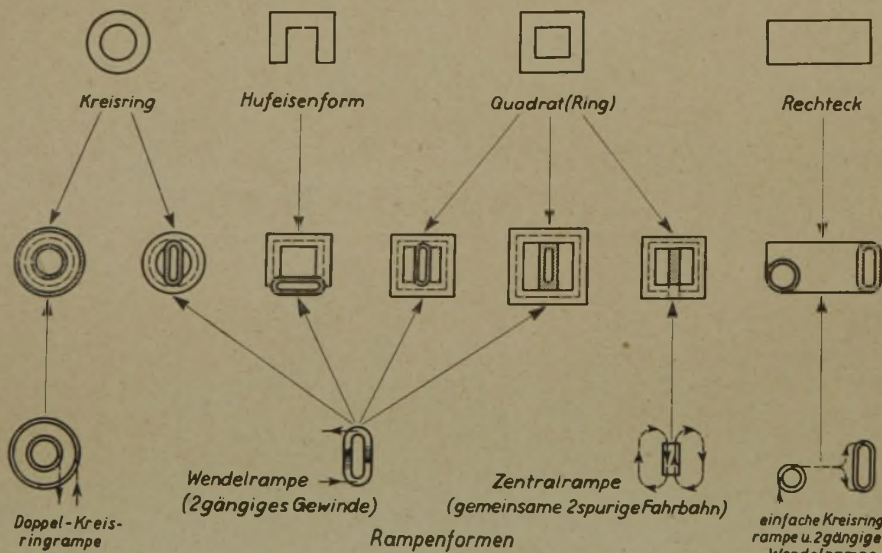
Verschiedene Grundriß- und Rampenformen.
